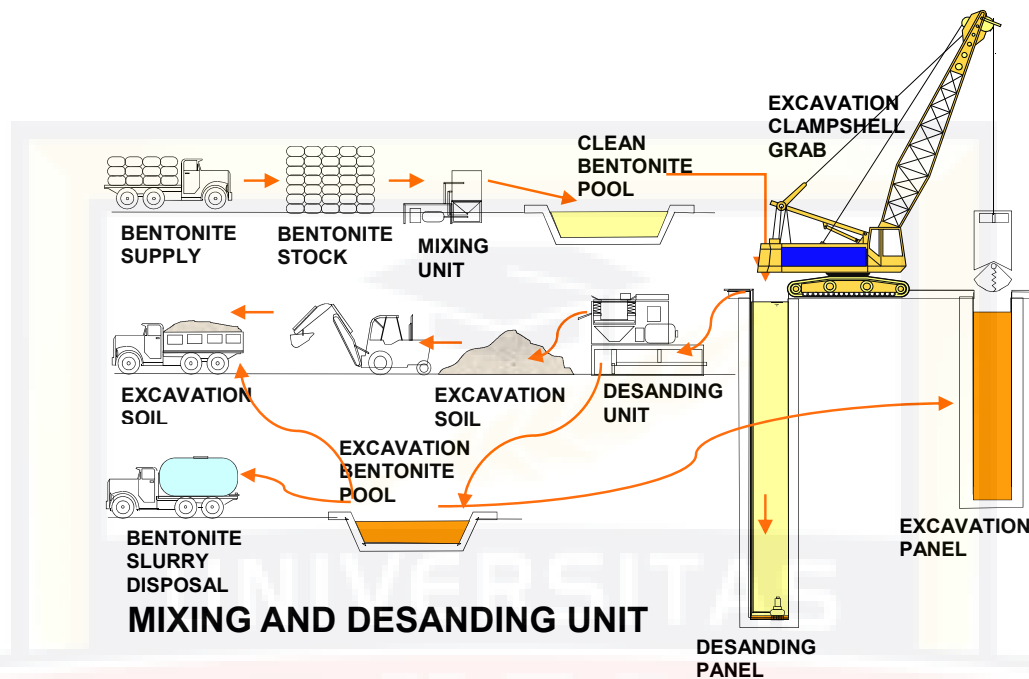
Sketsa Pekerjaan Diafraghm Wall
